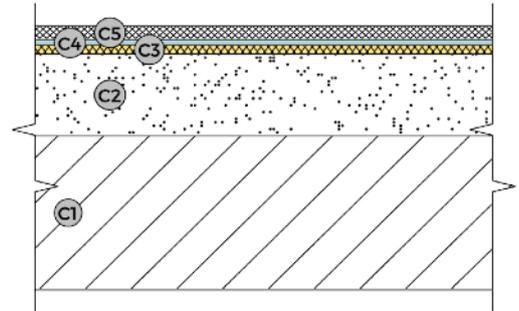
Résultats sur l'outil Totem, pour le plancher sur cave premier scénario. Source : www.totem-building.be
